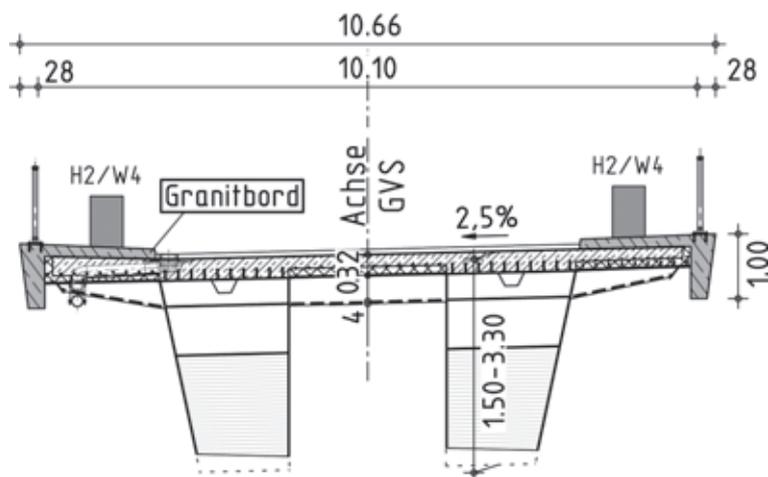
Querschnitt Überführungsbauwerk Typ 1
